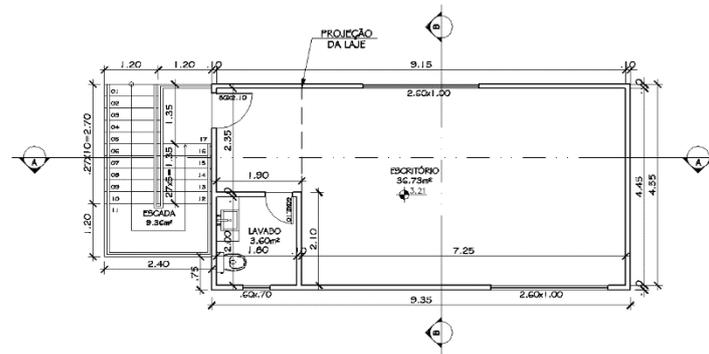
Planta Baixa Pavimento Térreo – Galpão
